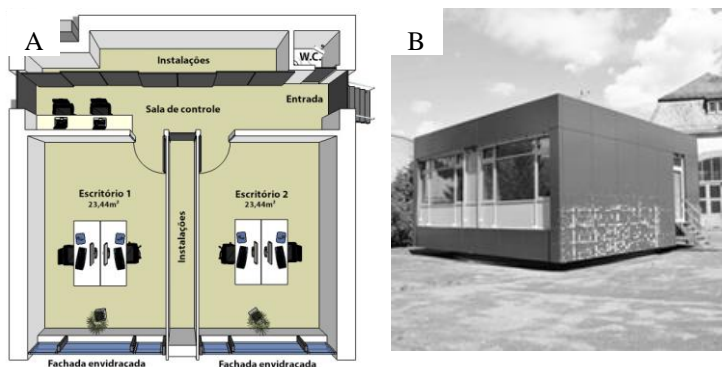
(A) planta LOBSTER; (B) vista geral com fachada envidraçada
